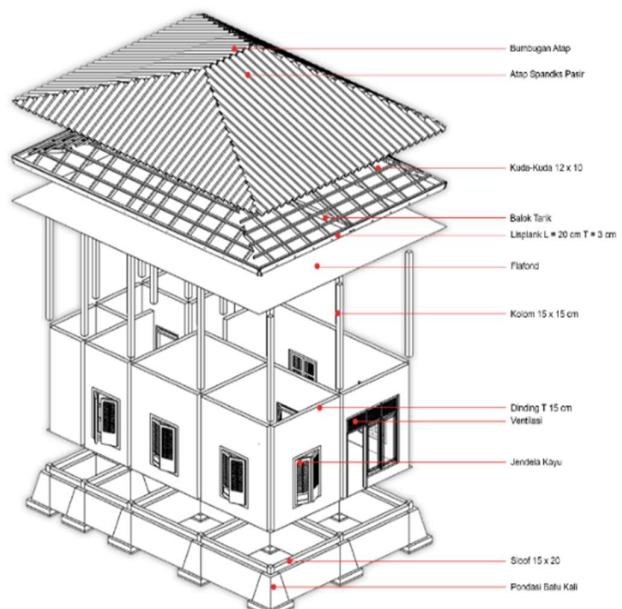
Penerapan Arsitektur Perilaku Tipe 48
